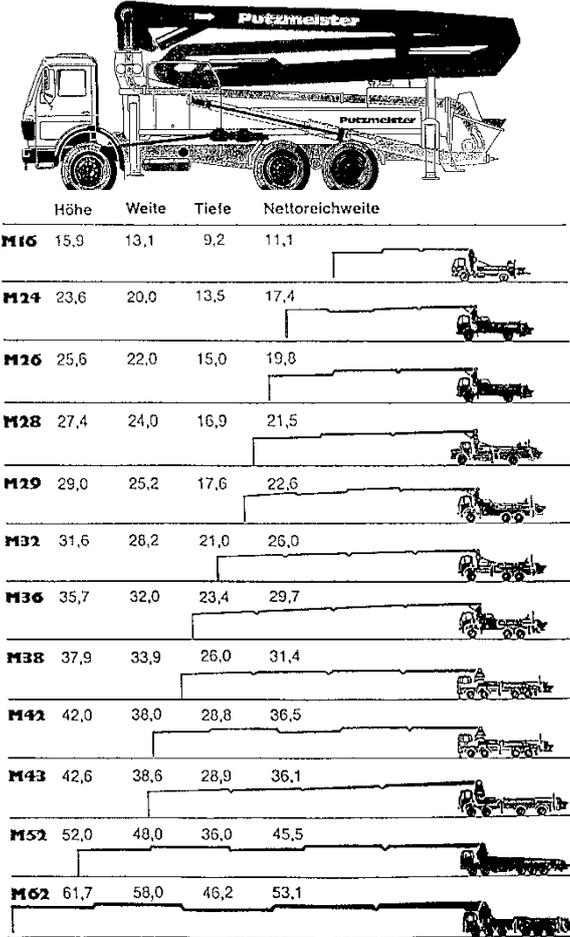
Autobetonpumpe – Einsatzbereiche [10]
